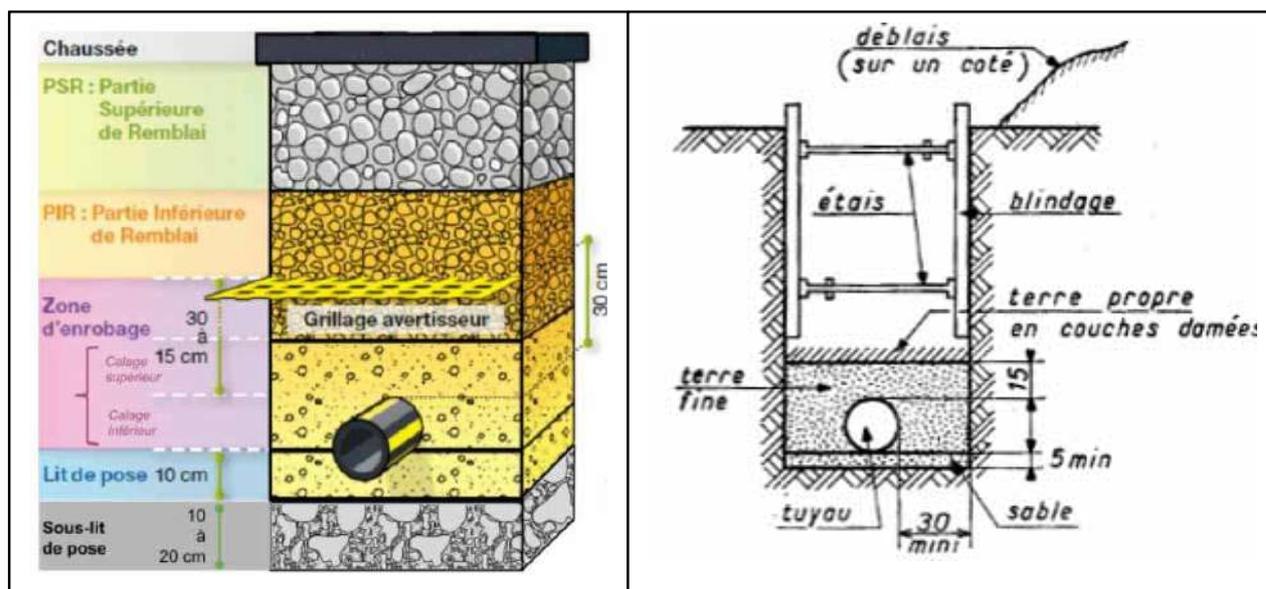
Coupes types de tranchées simples sous chaussée et avec blindage (wikitp/Asbadri)
